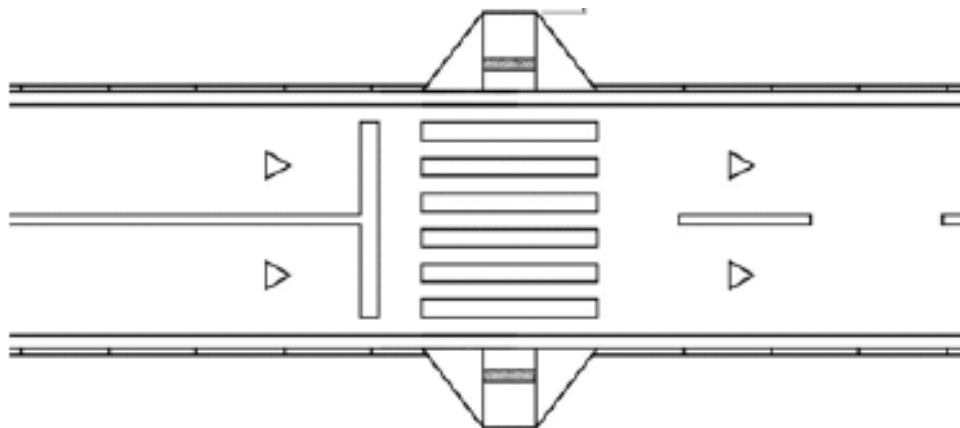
A rampa de acesso deve ter a faixa de pedestre na sua continuação e obviamente outra rampa de acesso do outro lado da rua.
